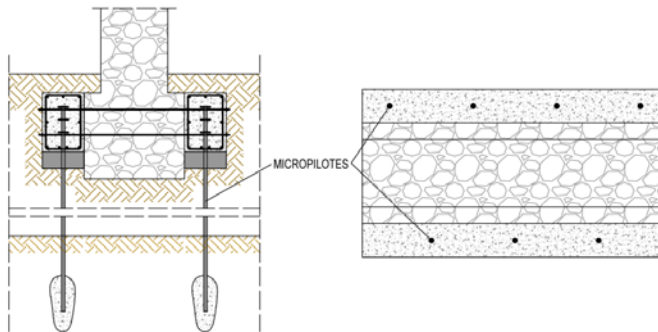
Refuerzo 2 mediante micropilotes de zapata corrida bajo muro. Fuente propia.
